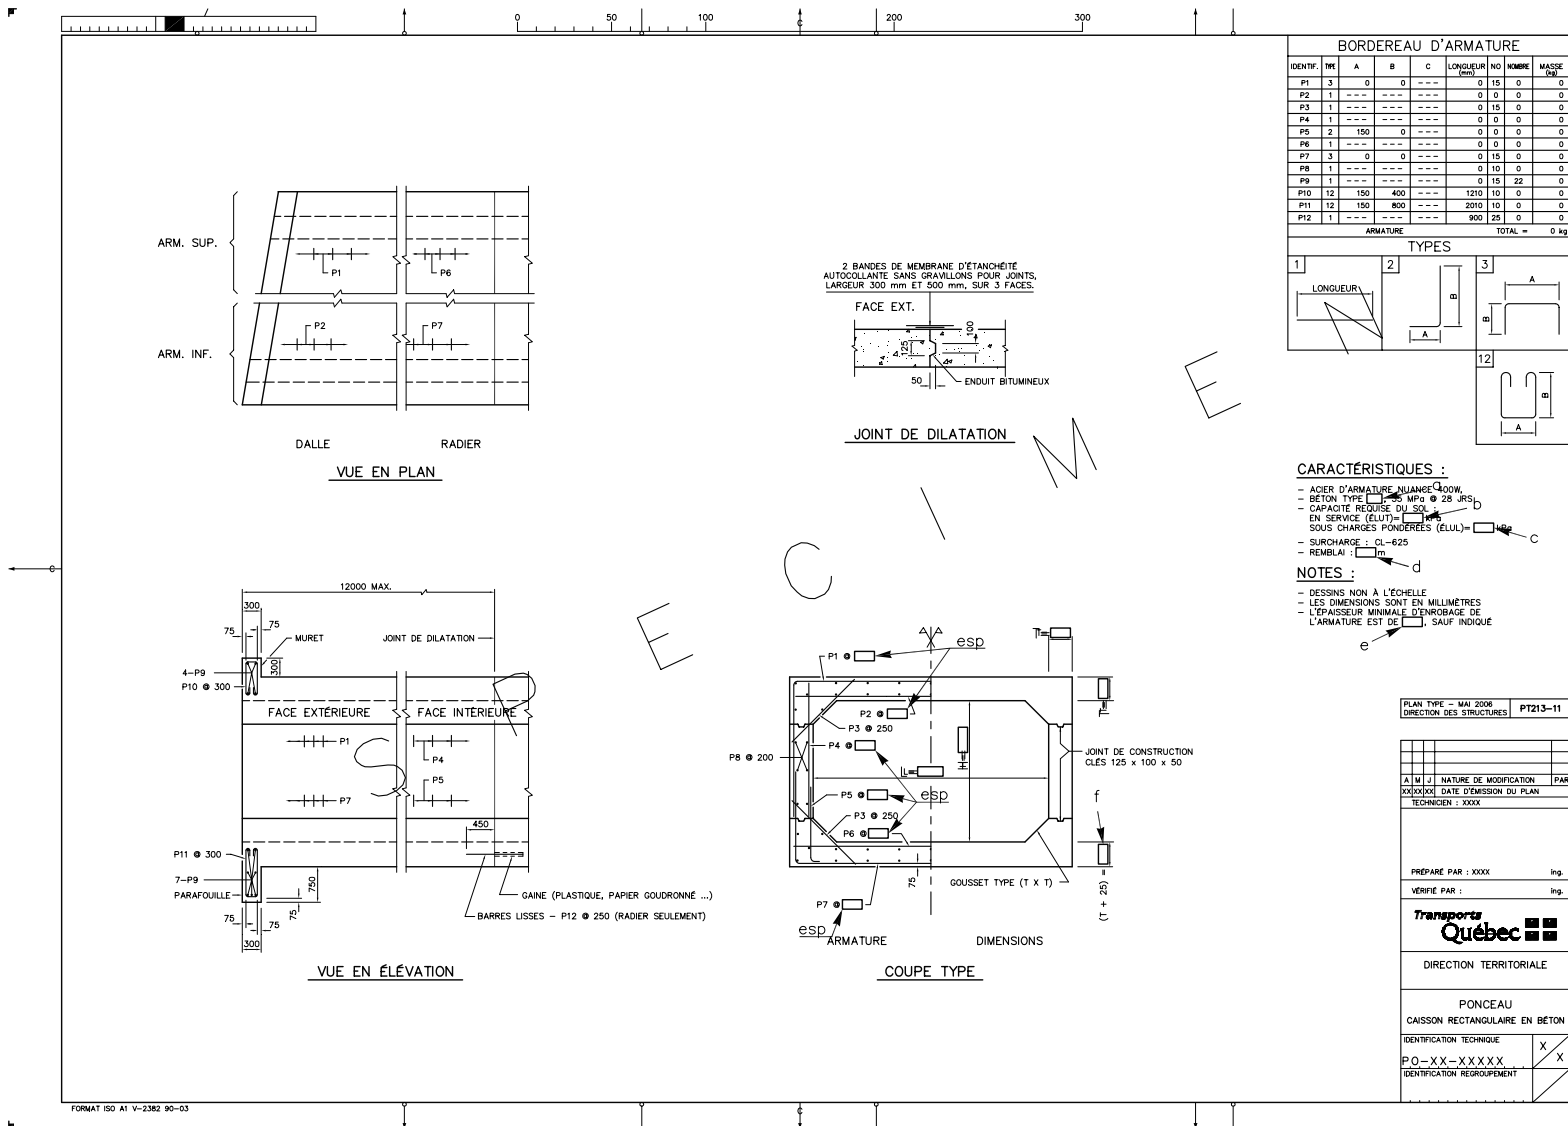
Ponceau rectangulaire en béton armé – Plan type PT213-11
